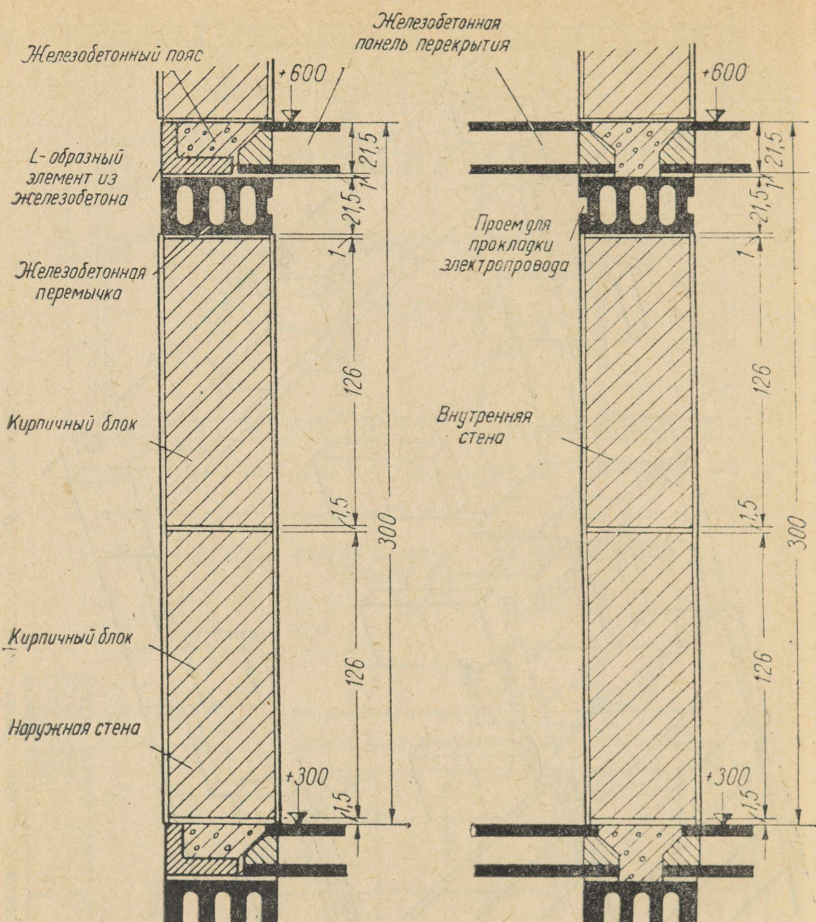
Панель перекрытия опирается на наружную и внутреннюю стены.
